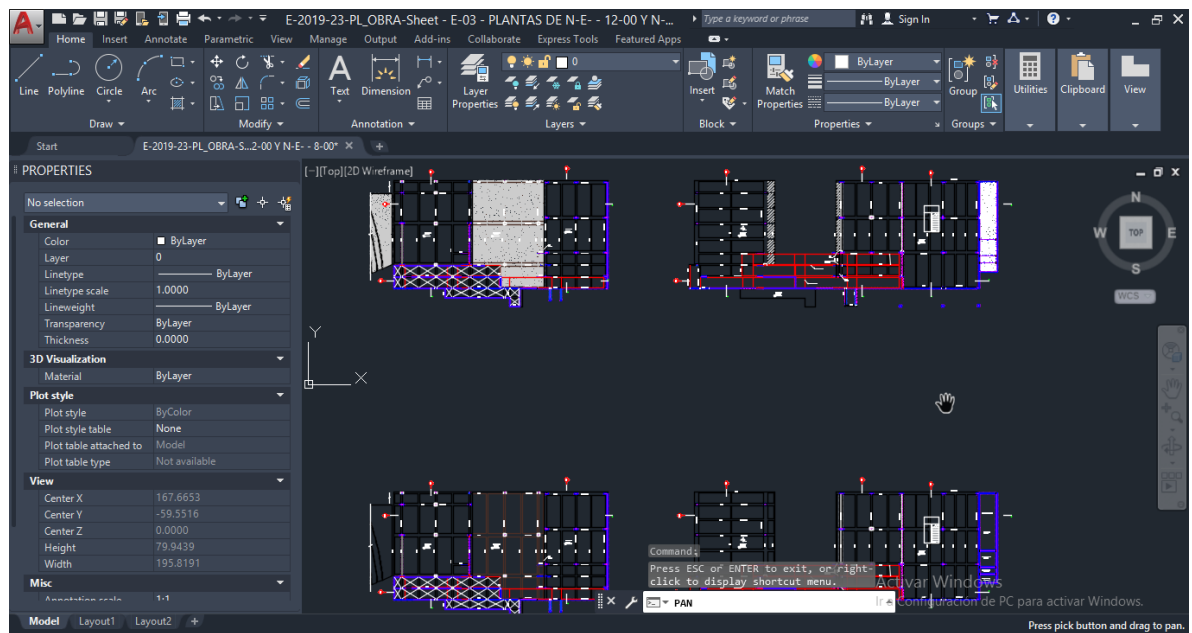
Plano del diseño estructural de la planta del Proyecto CDSD
